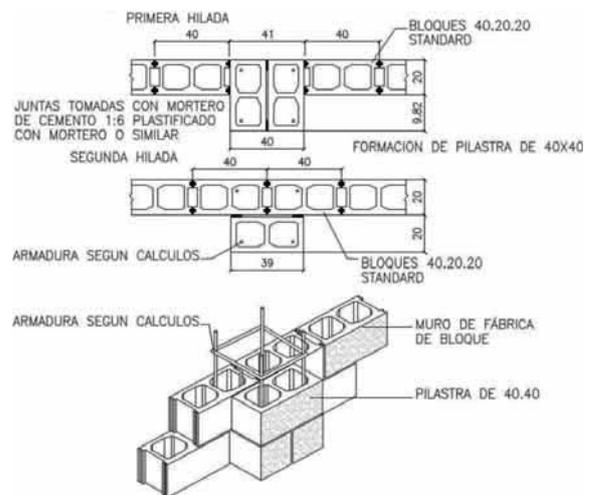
Pilastra sobresaliente de hormigón armado hecha con bloques normales.
